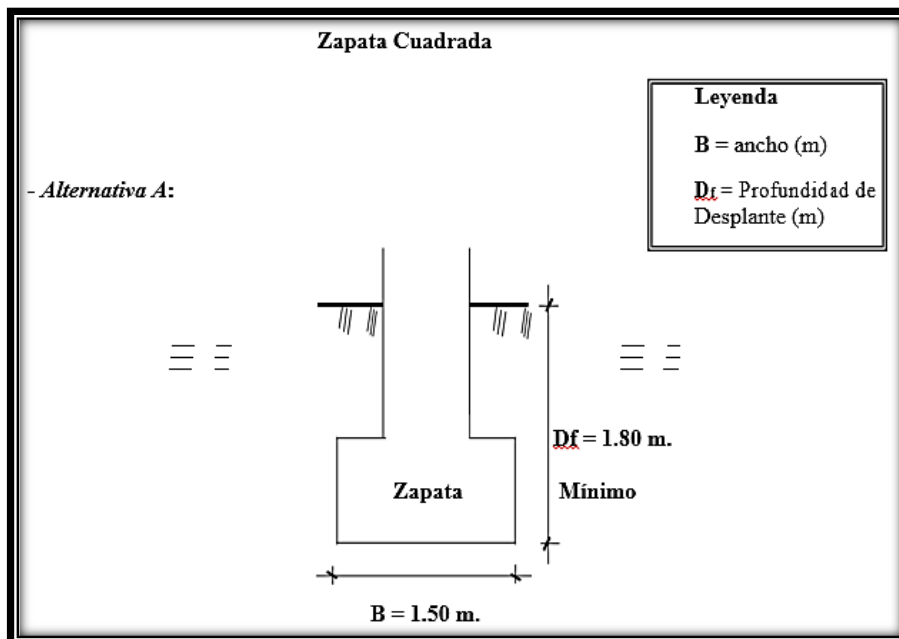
Detalle De Zapatas (Estudio de Suelos)
